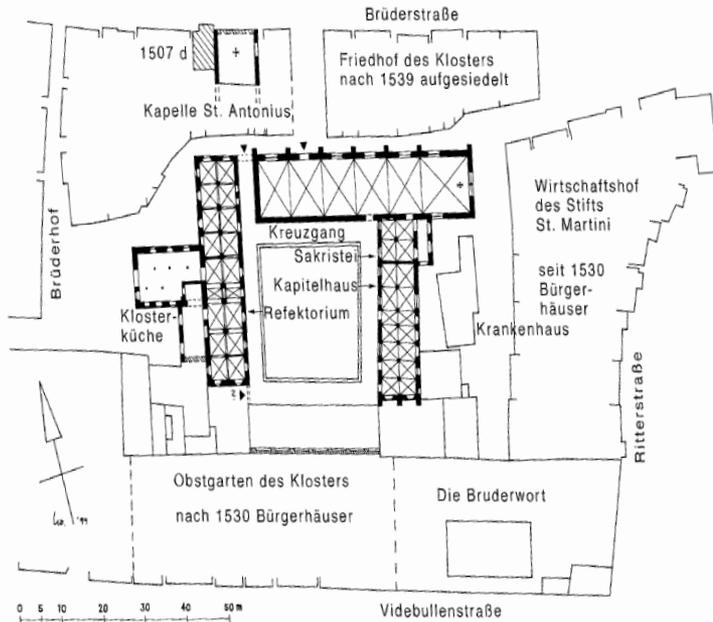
Alte Kirchstraße 9–15, ehemaliges Dominikanerkloster. Lageplan und Grundriß nach Umbauplan für die Alte Kirche (Zingerlin 1770), Grundrissen des Westflügels (Wegelin 1822) und des Ostflügels (Graff, Fabra um 1820) sowie Plan des Bauhofes (Kloth, um 1820) und Katasterkarte (1828).
